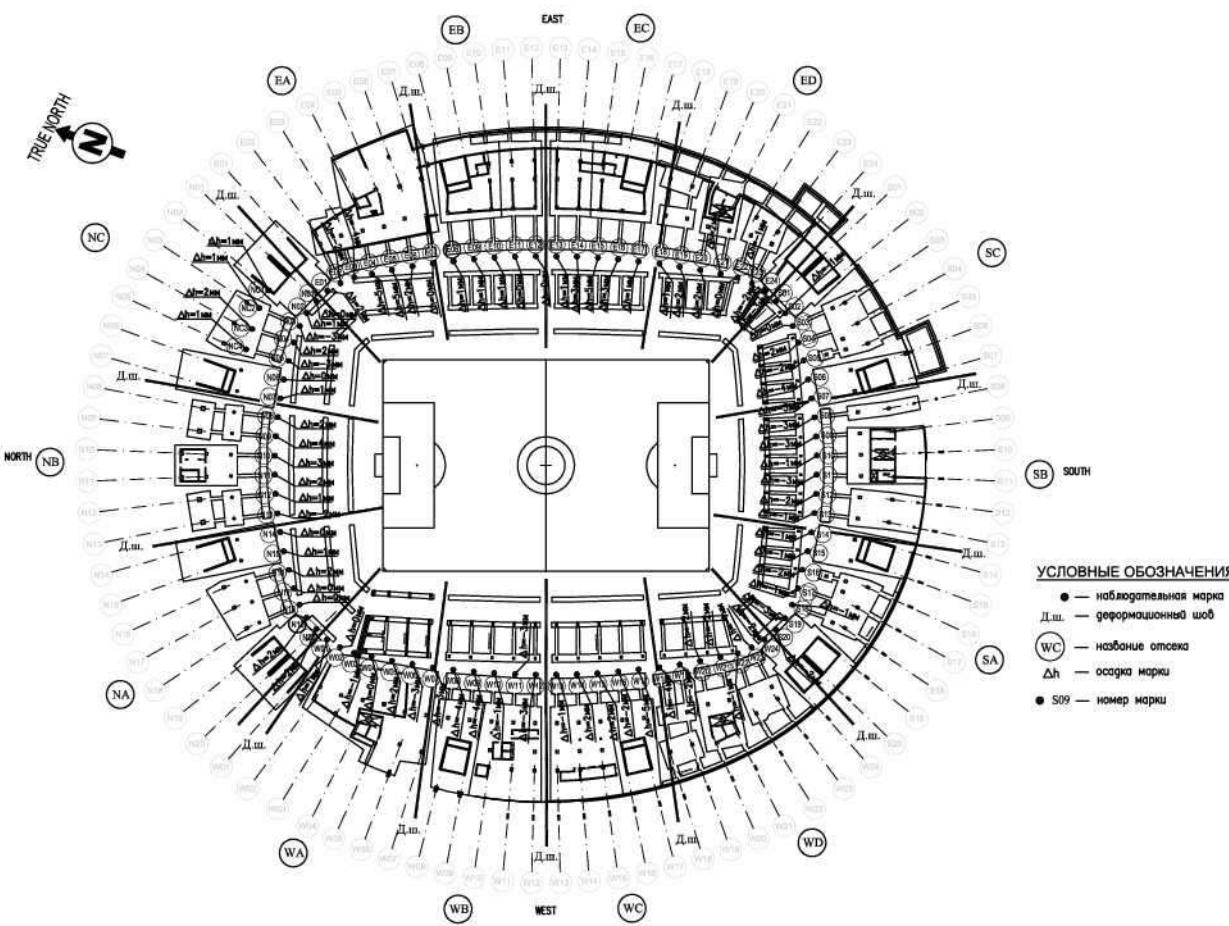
Схема вертикальных перемещений наблюдательных марок на колоннах несущего каркаса (3 уровень)
